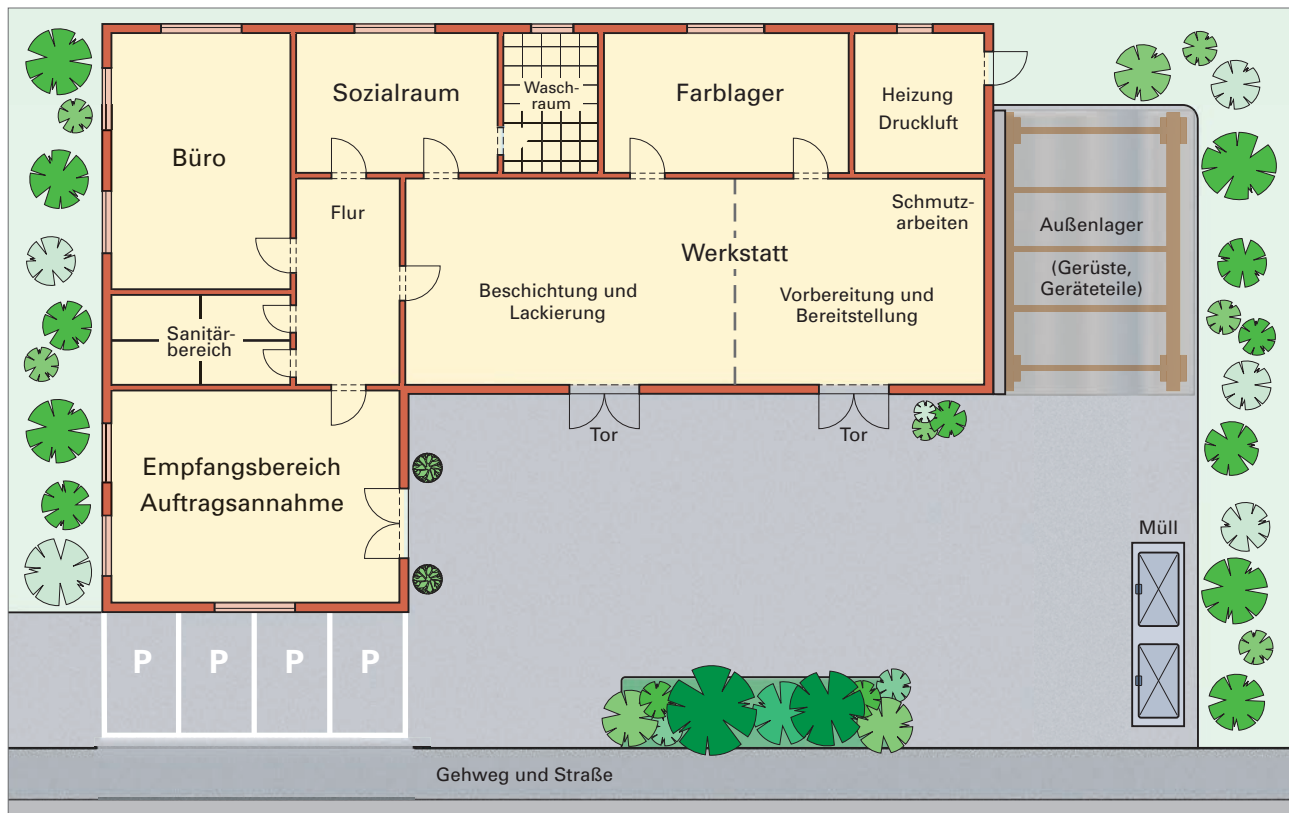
Möglicher Grundriss eines Malerbetriebes
